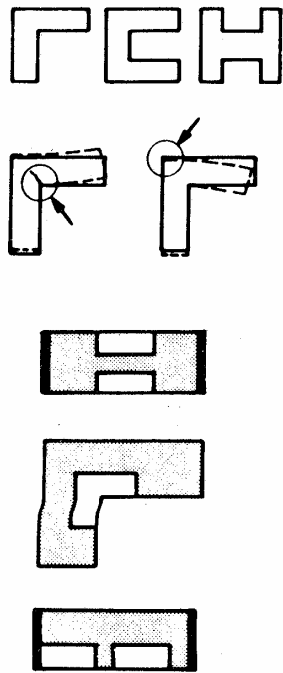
Plantas irregulares en edificios de mampostería (Paulay y Priestley, 1992)
